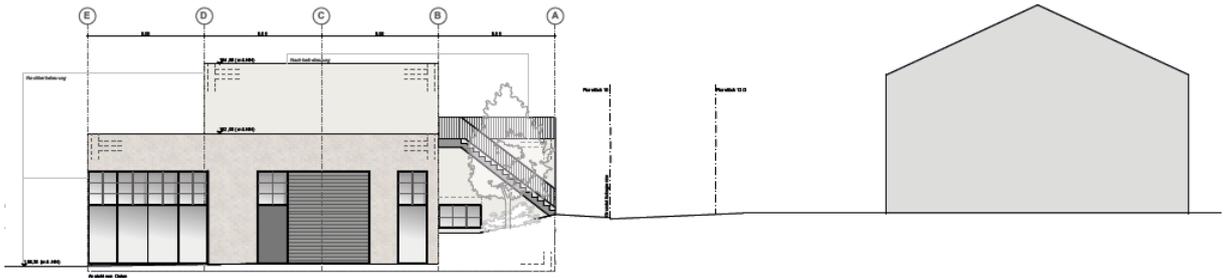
Ansicht Westseite mit Nachbarbebauung Retzgrubenweg 15 (Schaack + Schank Architekten, Stand: 04.01.2023)
